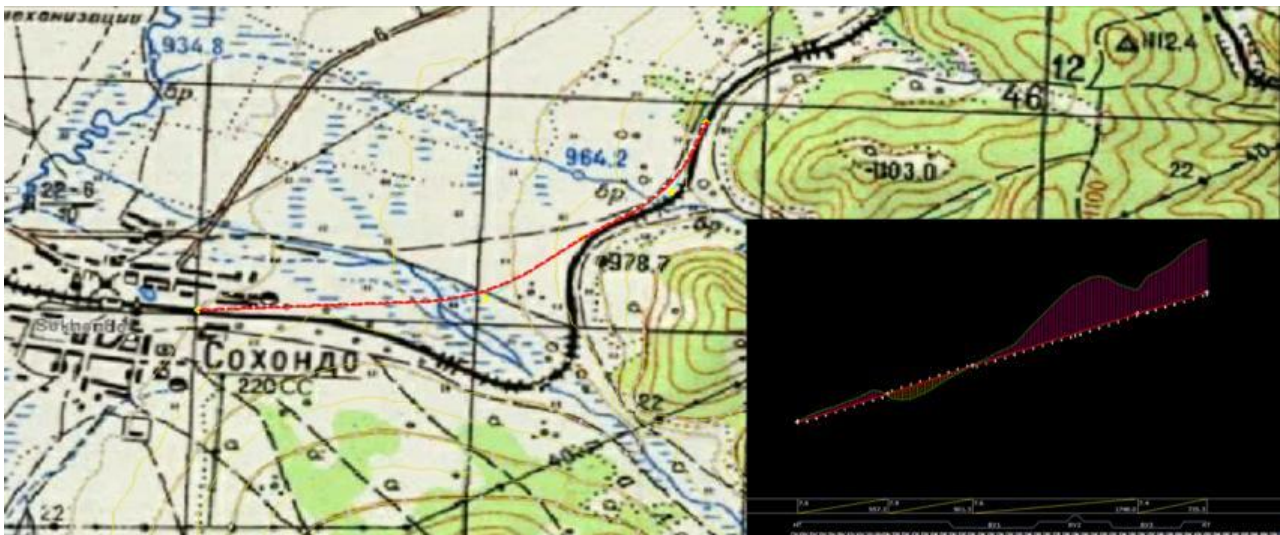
Реконструкция перегона Сохондо – Тургутуй
